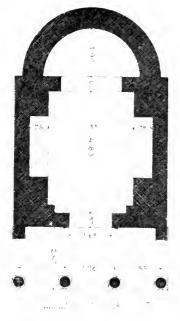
Grundriss des Heroons der T. Kl. Perikleia. Zweites Jahrhundert n. Chr.
